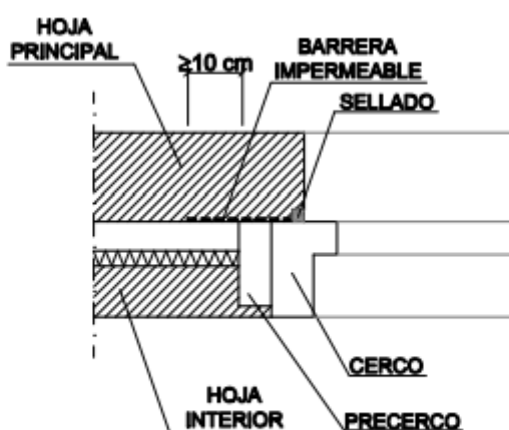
Exemplo de encontro de la fachada con la carpintería
